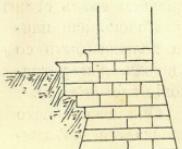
Указана ступеней въ наружныхъ крыльяхъ на выступахъ фундамента.
